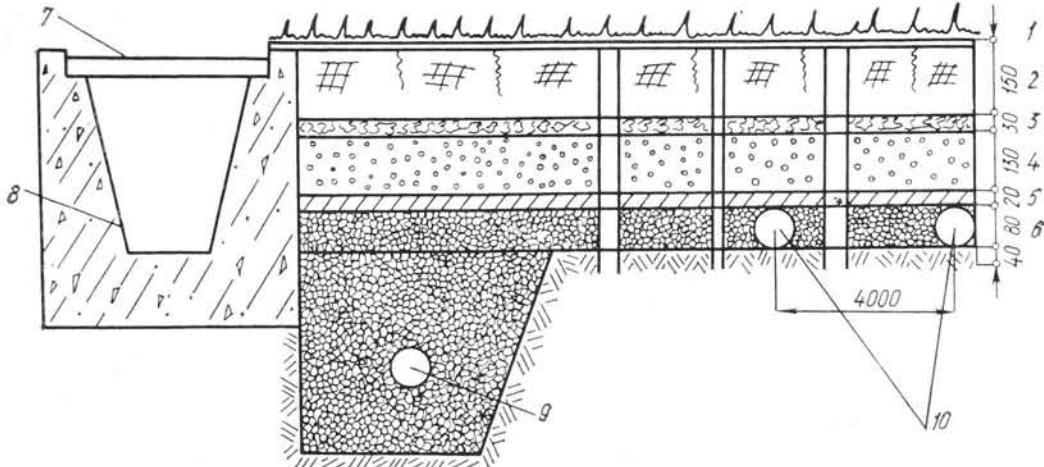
Строение дренажа и конструкция газонного покрытия:
